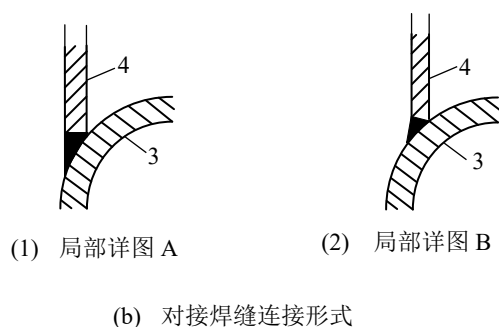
焊接相贯节点焊缝连接形式
